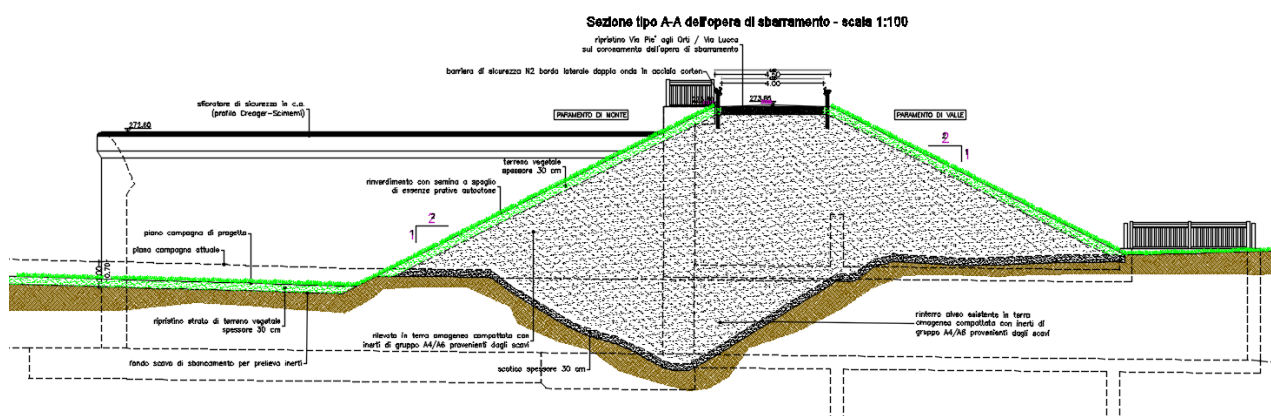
Sezione tipologica maestra dell'opera di sbarramento in terra omogenea compattata con vista dei manufatti di regolazione e scarico
